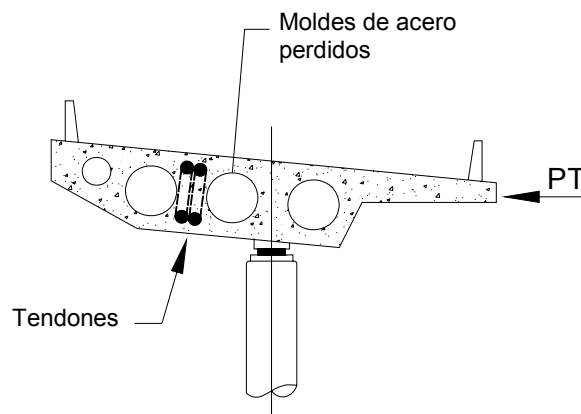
Sección transversal de un típico sistema de tablero aligerado
